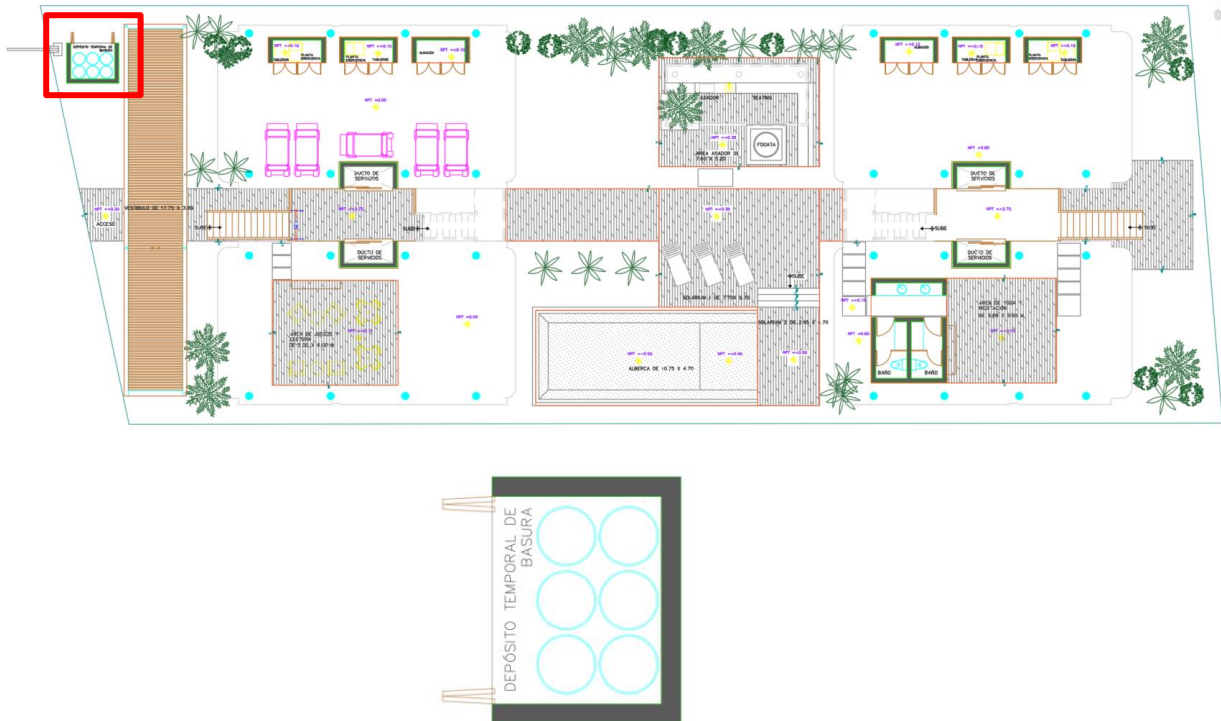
Plano de la ubicación del depósito de basura en el proyecto
